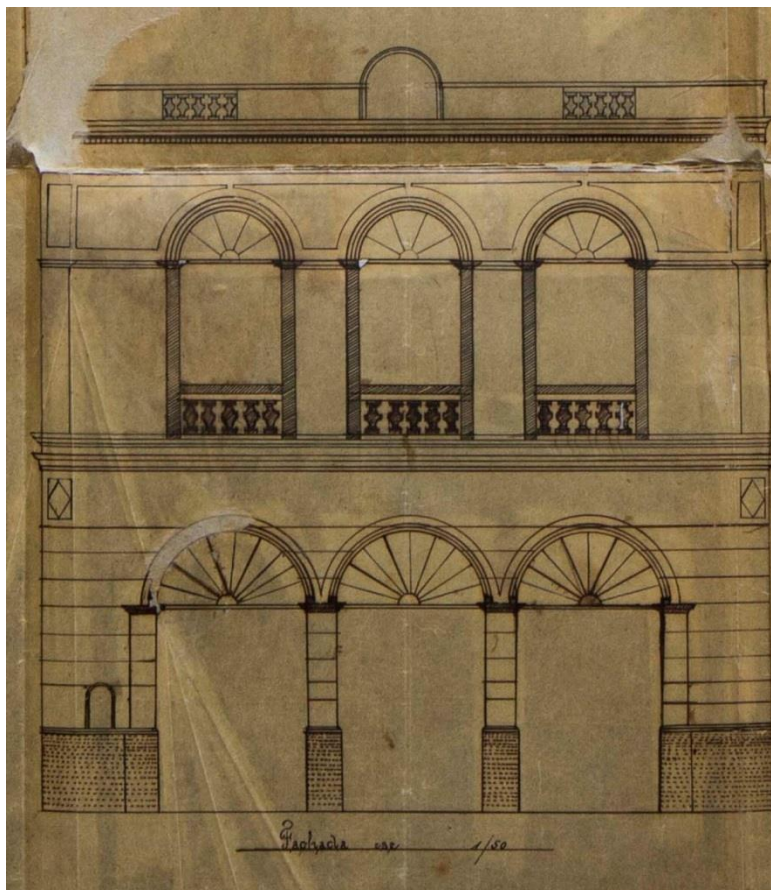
Fachada, Rua São João, 115. Fonte: AHSP, OP cx 12, 1906.
